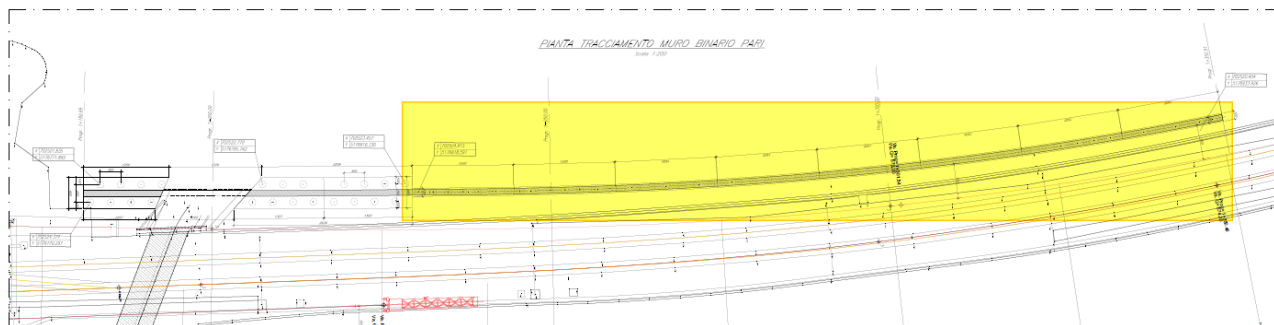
Individuazione Muro in c.a. su fondazioni profonde binario pari – Planimetria
